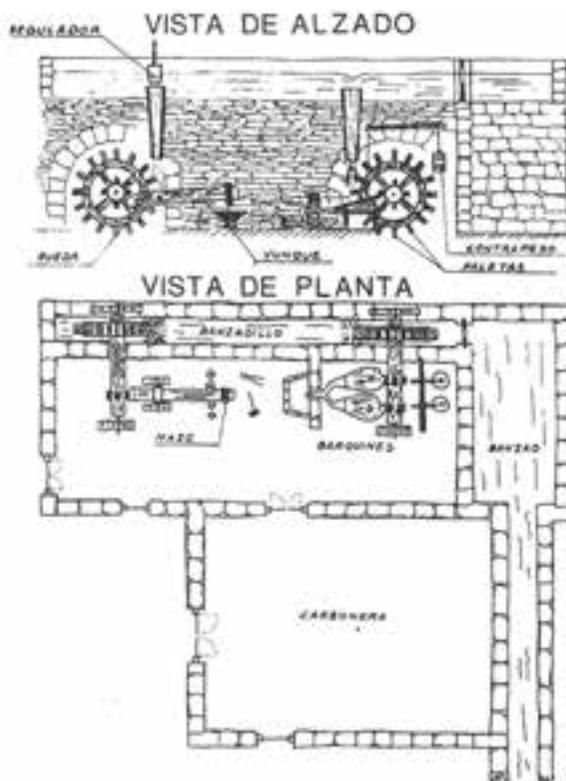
Planta y Alzado de un Ferrería del Noroeste de España (Dib. P. G. Cotado).
